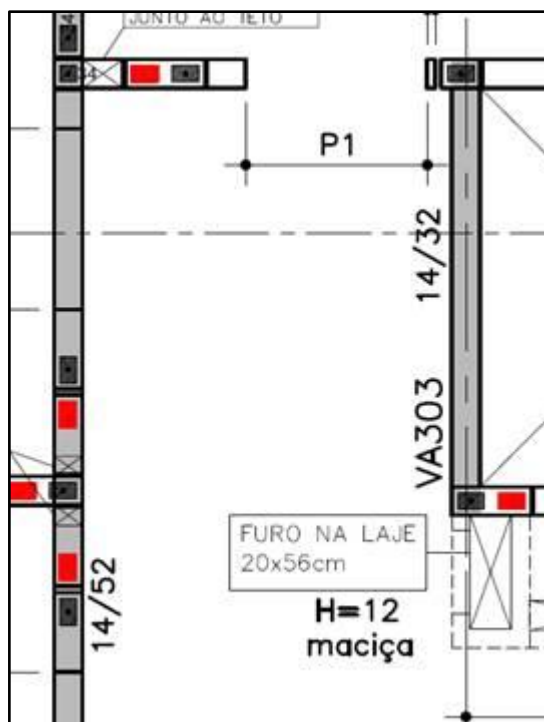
Projeto estrutural pontos de grout (fonte: empreendimento estudo de caso)
